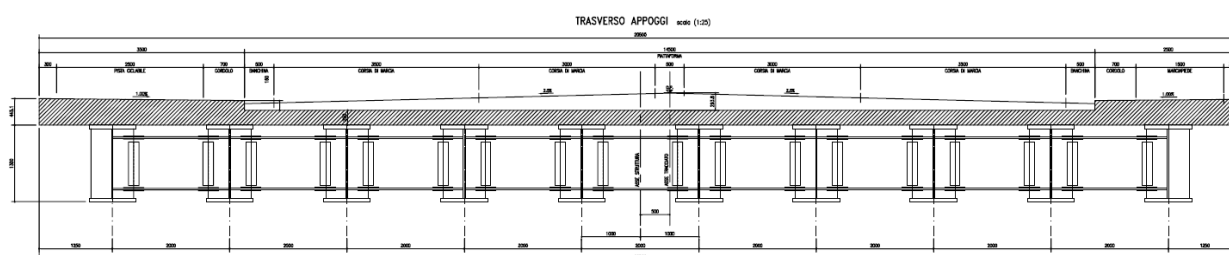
Sezione tipo del traverso di spalla/pila (T1)
